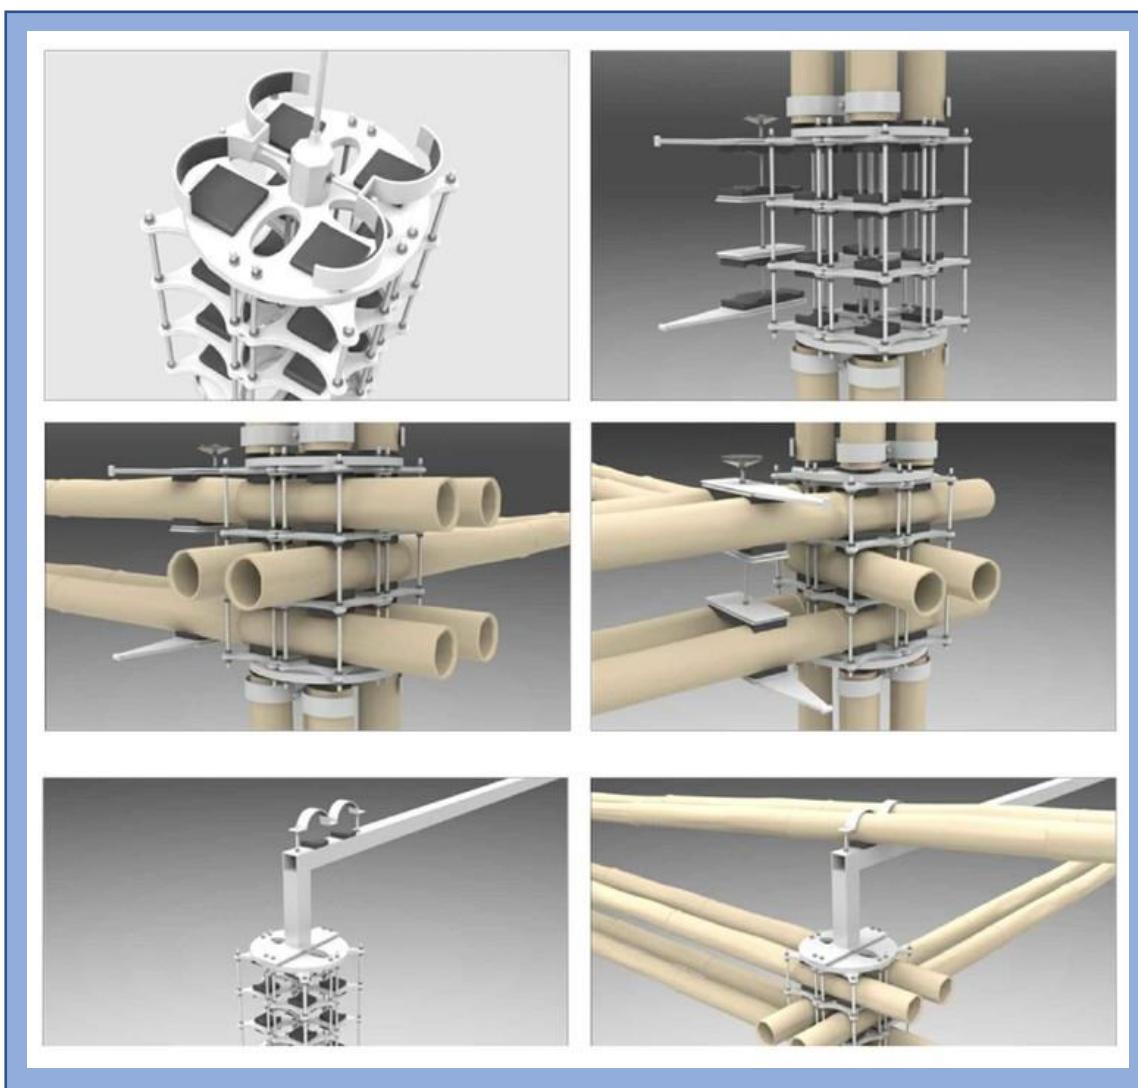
Fuente Plataforma Arquitectura, Detalle de ensamblajes.
